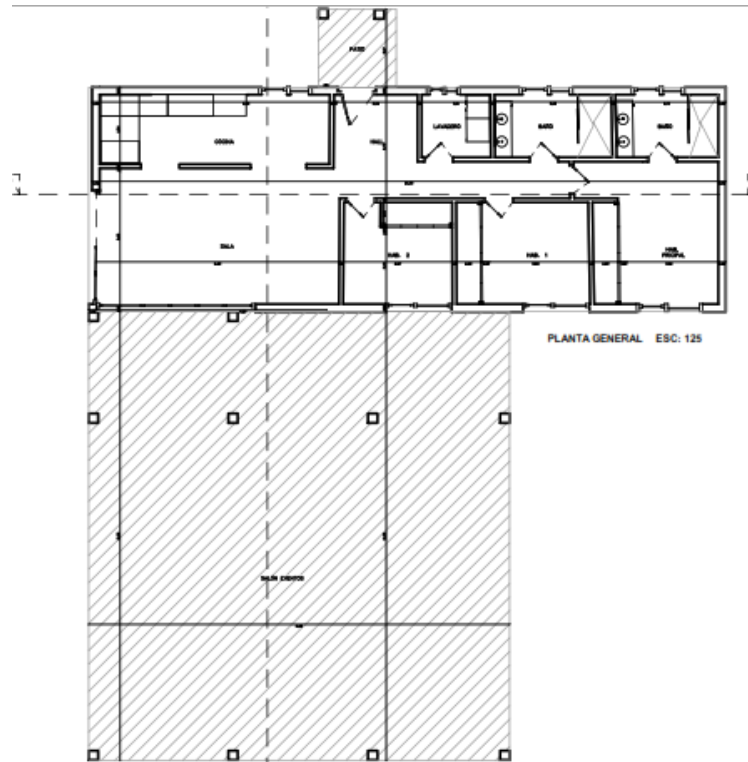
Vista en planta general propuesta de vivienda número uno.
